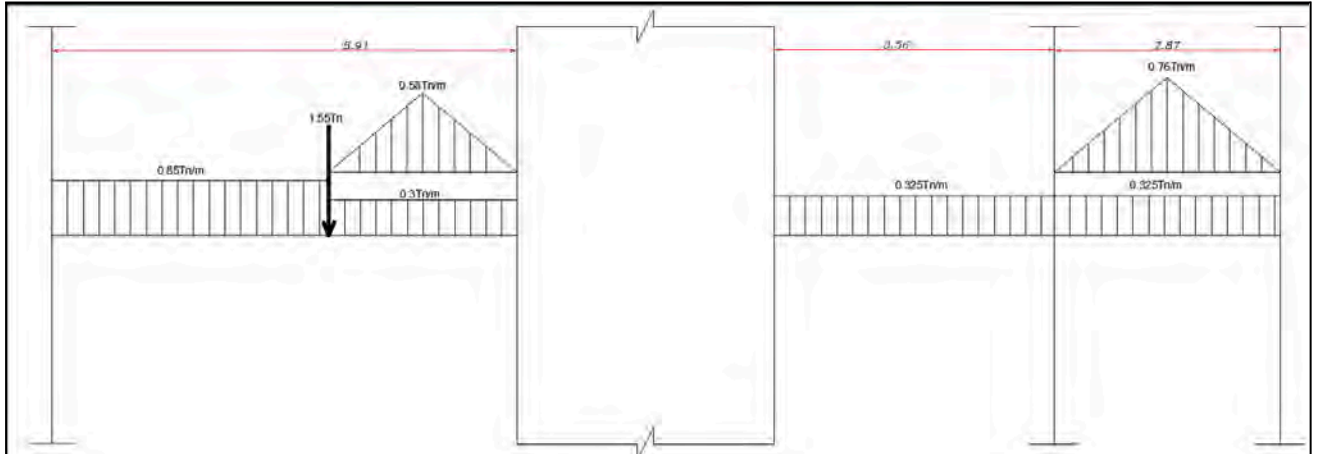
Reparto de las cargas muertas sobre la viga V-22
